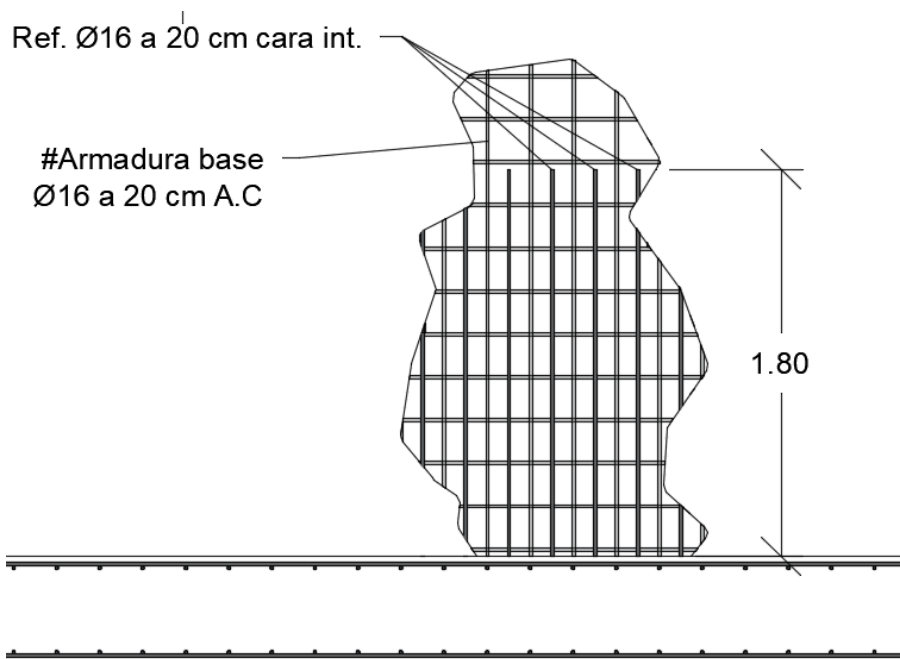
Refuerzo en muro externo 4 y 7 centro (armadura vertical)
